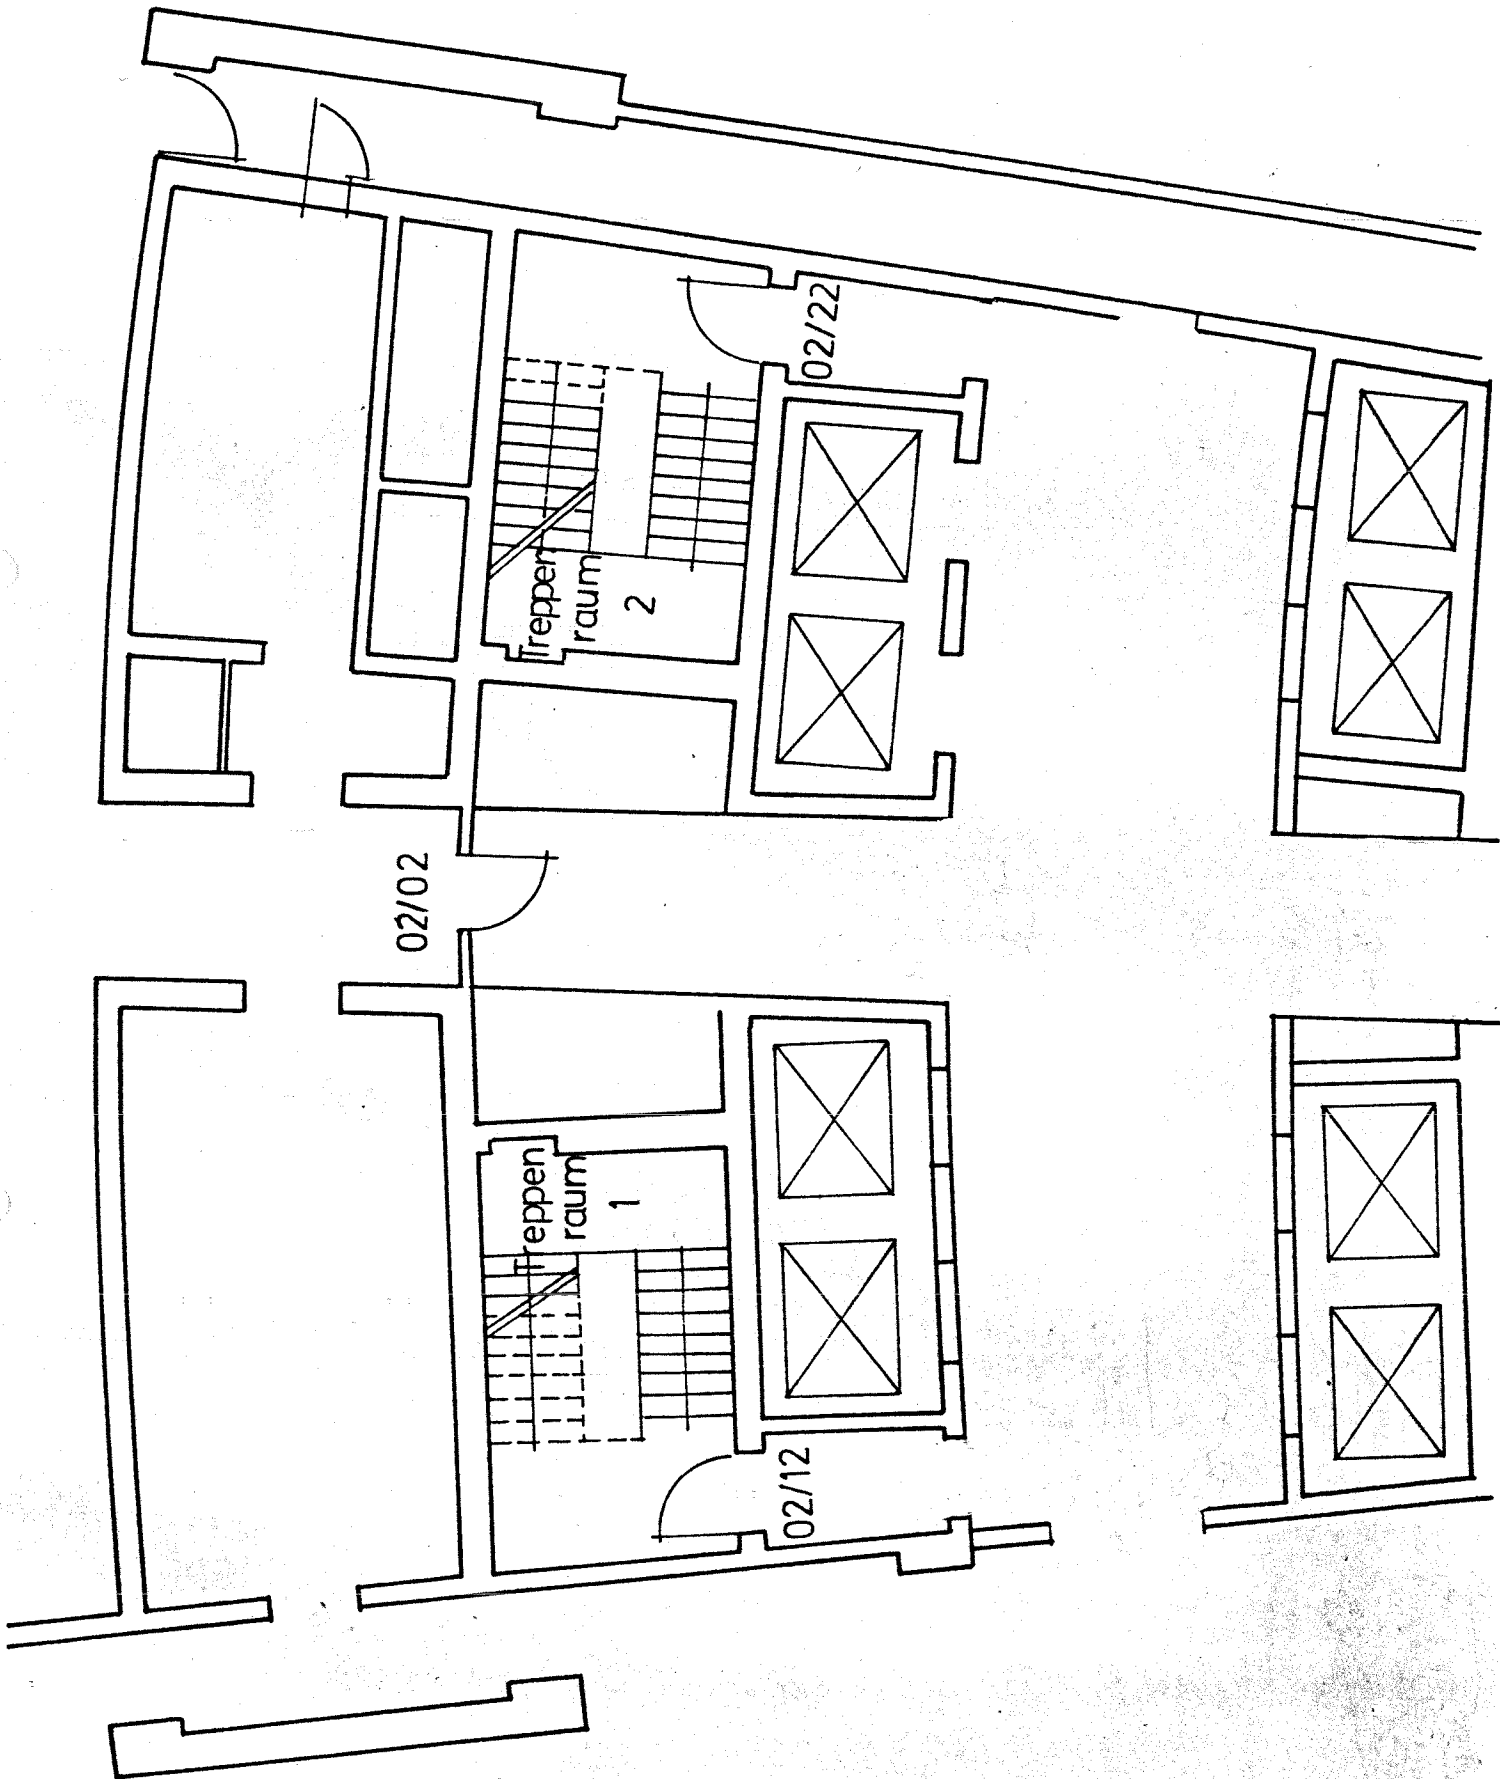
2.Untergeschoß, eingebaute Türen beim Brandversuch
